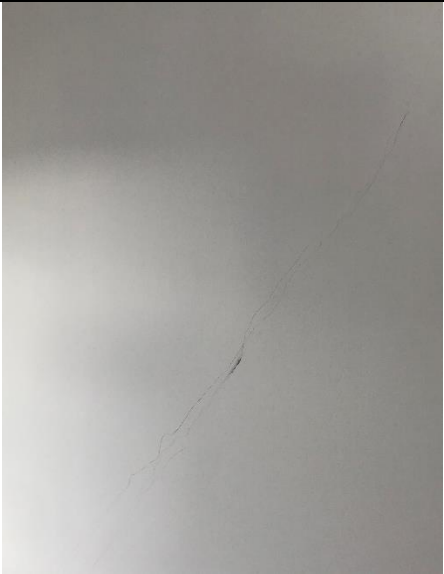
Reparo realizado nas fissuras embaixo da janela do empreendimento B
